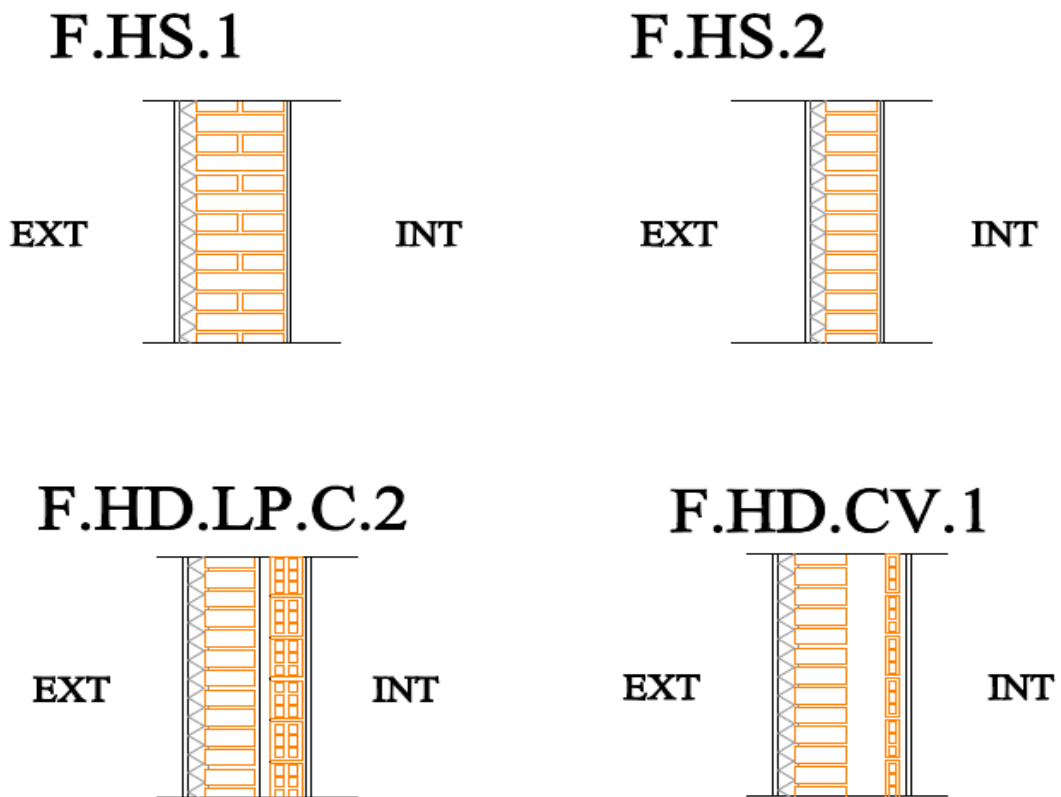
Reforma exterior de fachada con mortero termoaislante
